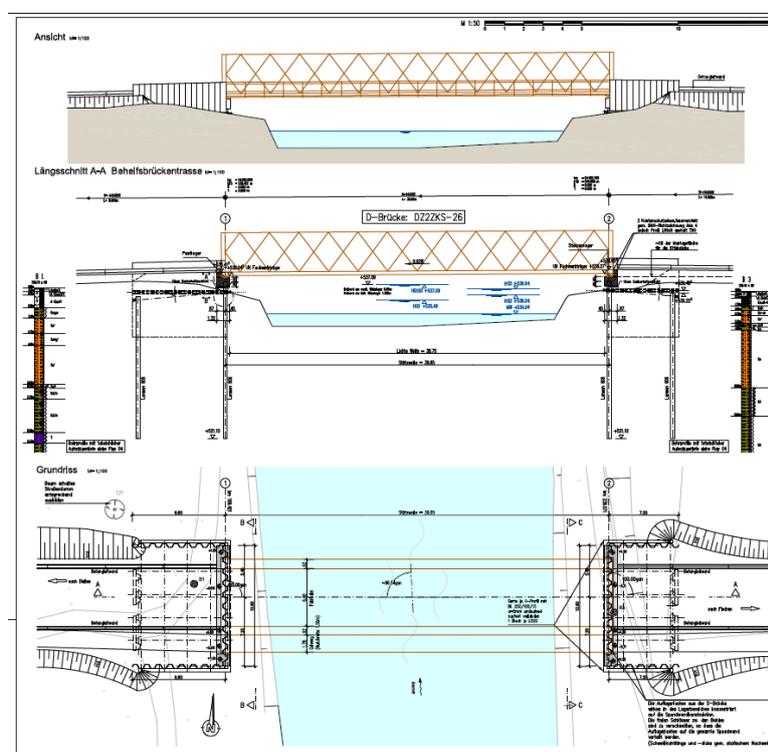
Ausschnitt aus dem Plan zur Behelfsbrücke
